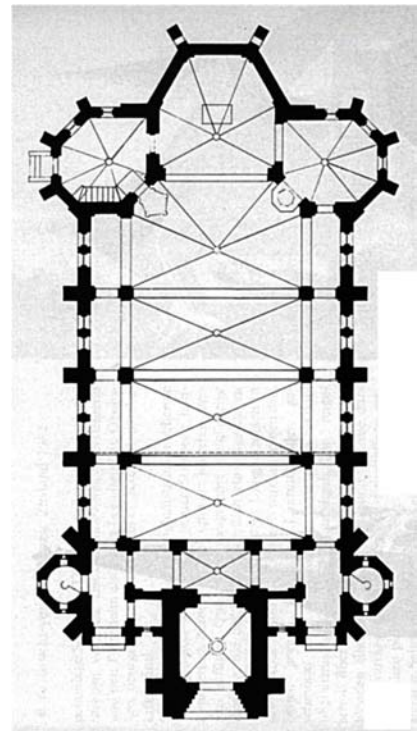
Grundriss, Anordnung der Prinzipalstücke
